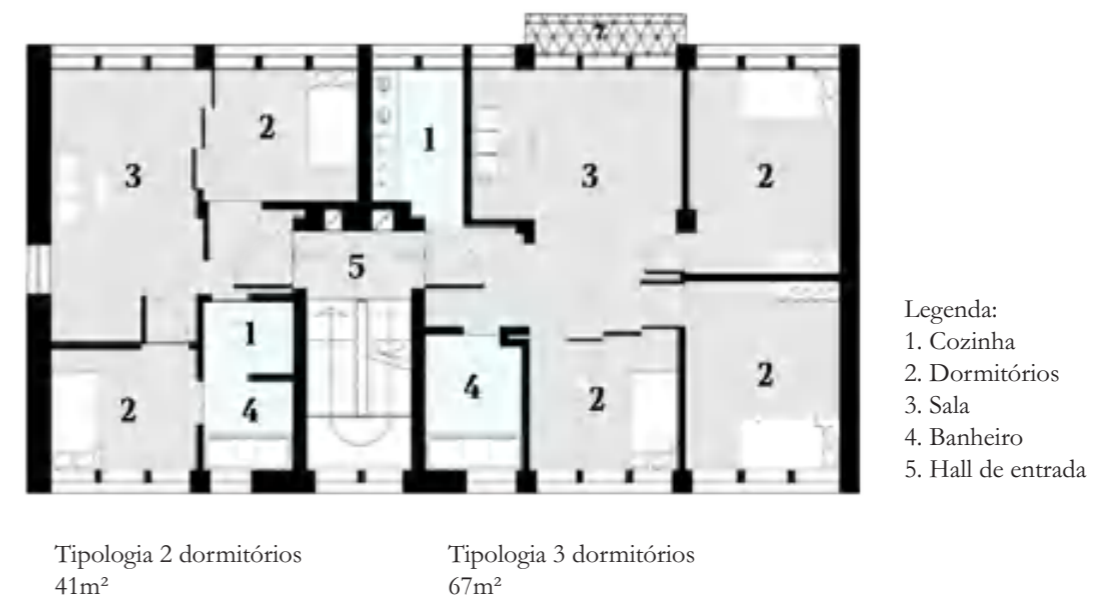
Exemplos de plantas dos apartamentos Weissenhof.
